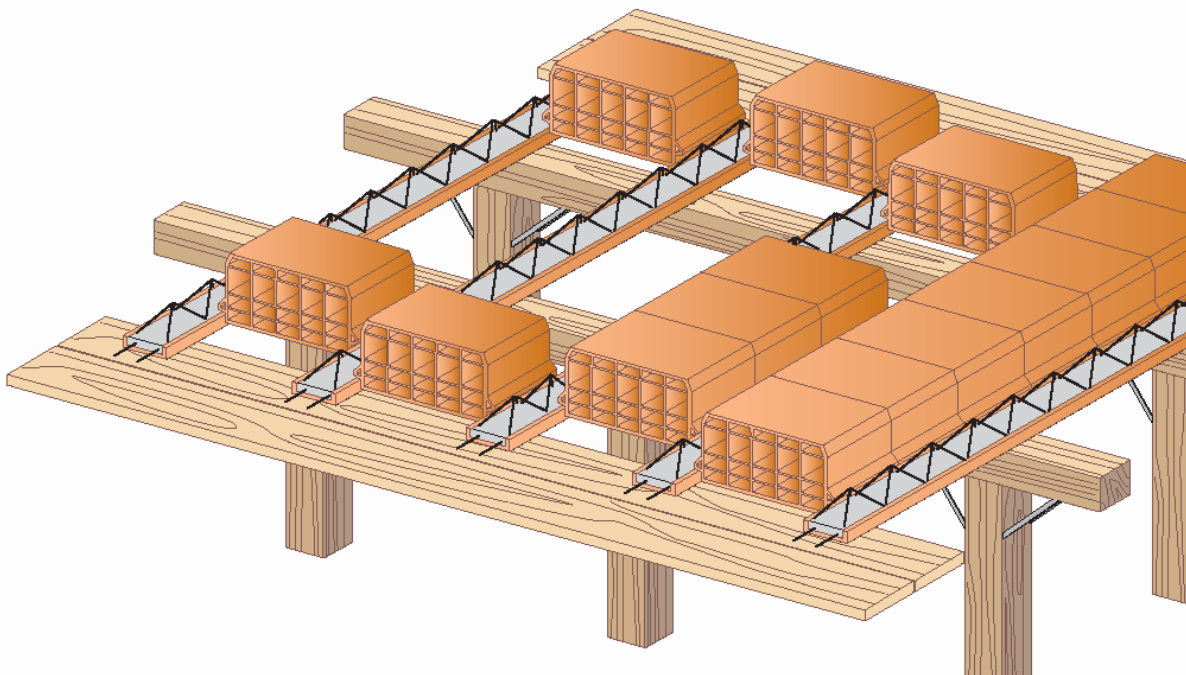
Solaio a travetti. Il rischio di caduta dall'alto permane anche successivamente alla posa dei travetti³⁶
